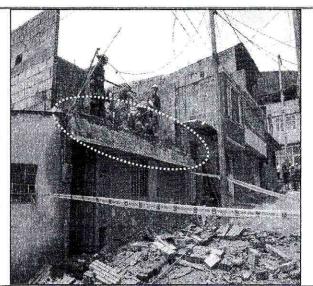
Vista de la fachada de la edificación ubicada en el predio de la Carrera 11B No 48J-21 Sur. Se observa la placa de concreto en voladizo que presentó falla...
